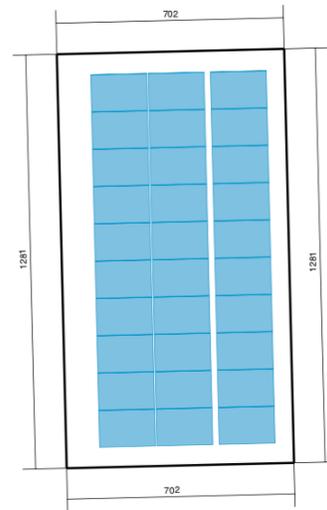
1.Gangstrasse 11.3, Belegungsplan der Dachfläche
